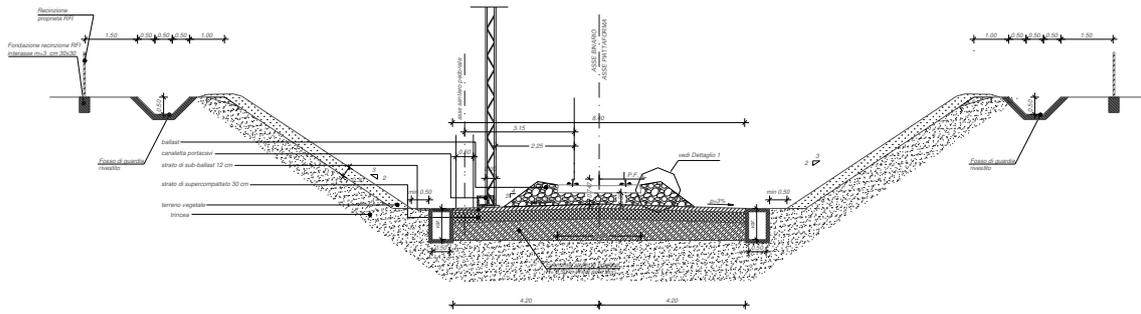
Sezione tipo ferroviaria in trincea a singolo binario in rettilineo
